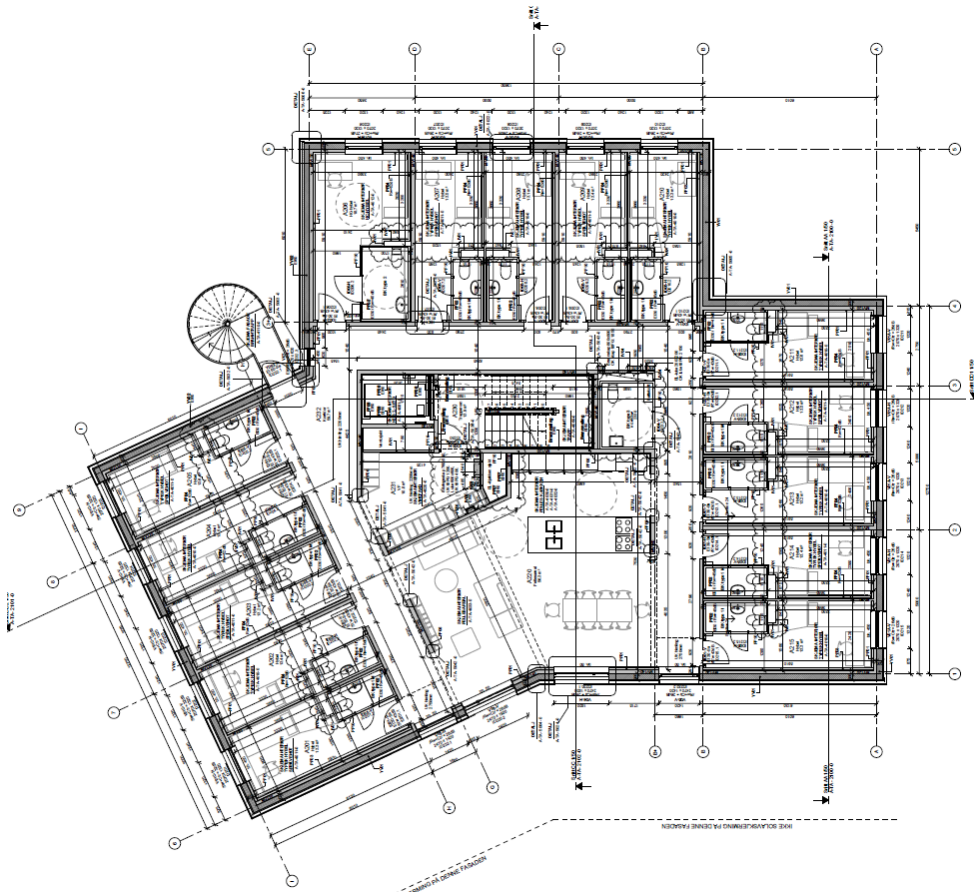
Grundriss Regelgeschoss [MDH/Woodcon AS]
